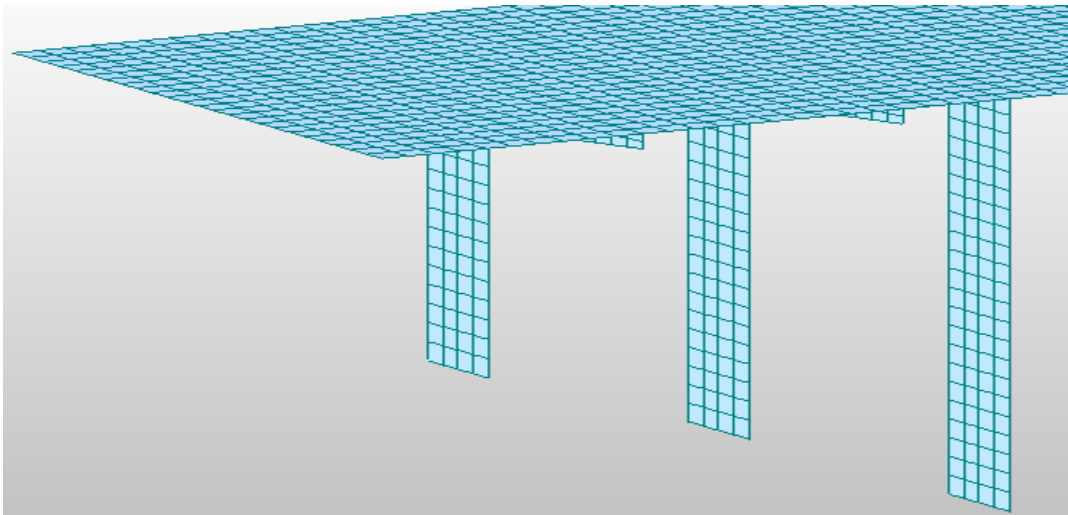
Vista en perspectiva de las pilas de los estribos.
